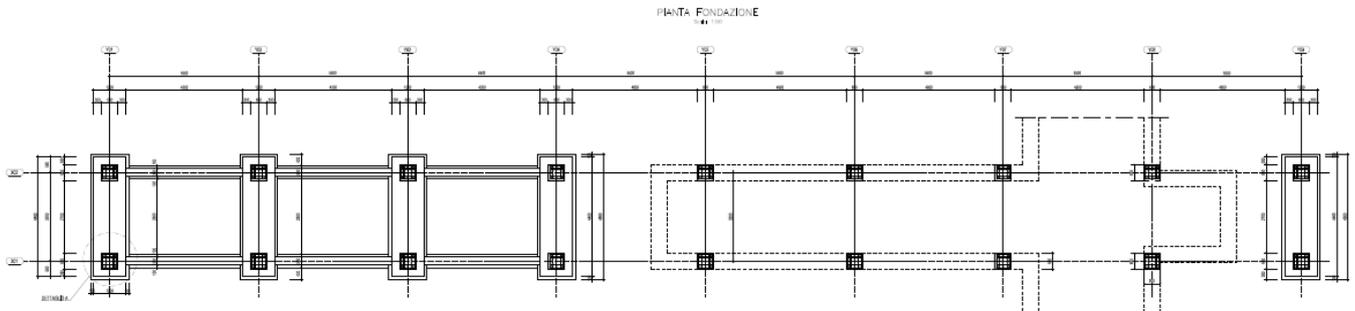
Pensiline – Pianta fondazioni - Pensilina Nord
